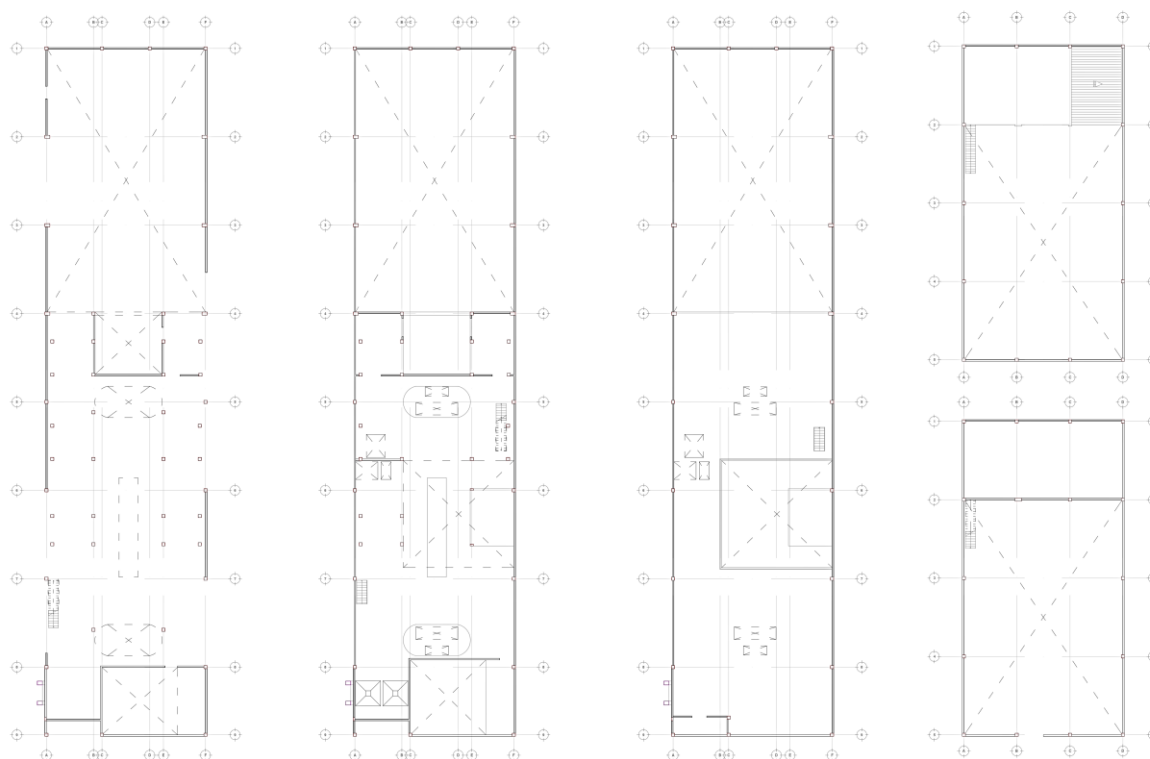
Levantamiento edificio preexistente. Fuente: Proporcionada por Docente.
